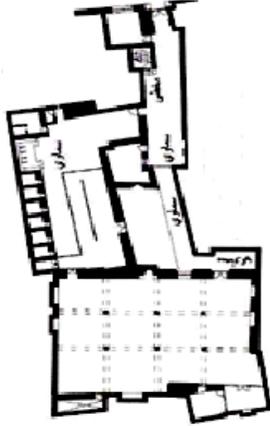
المسقط الأفقي لجامع القنائي بفوة.
